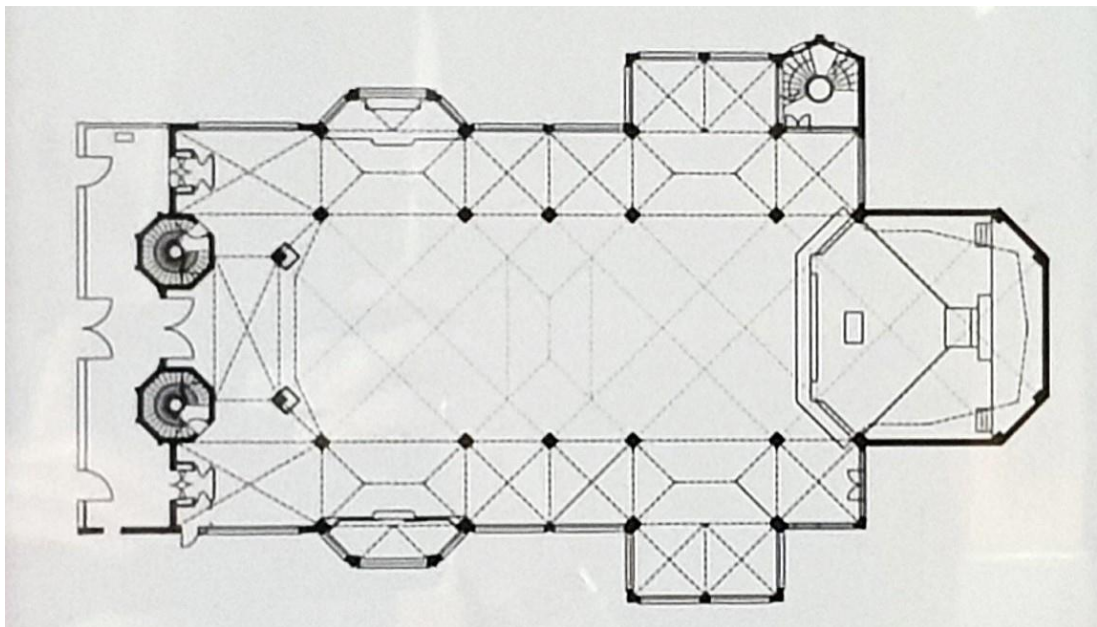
Grundriss des Kirchenbaus <sup>[32]</sup>
